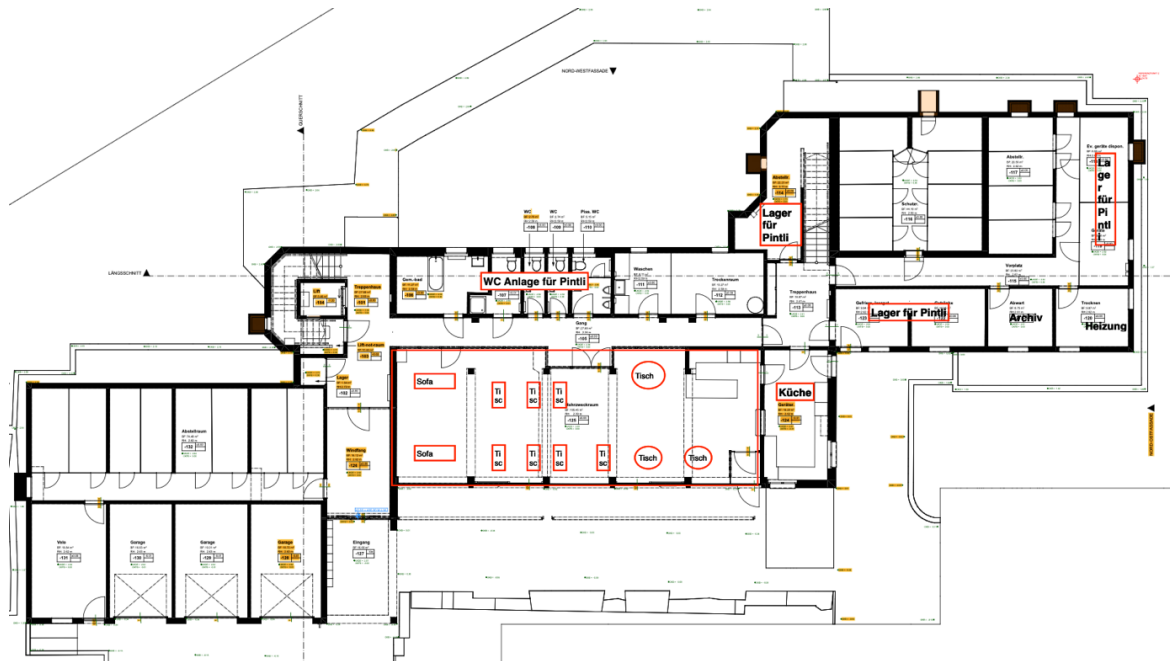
Grundrissplan Haus 8 EG – Aktuelle Situation
